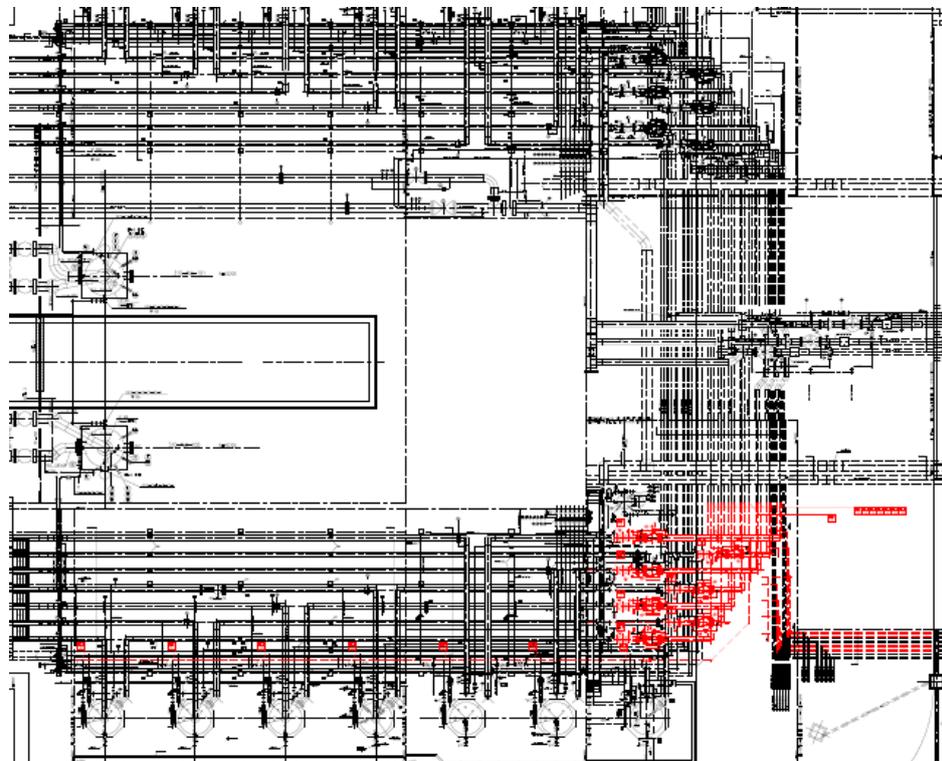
Planimetria Tie-ins di Centrale – Fase 1 (in rosso smantellamenti Fase 1)
